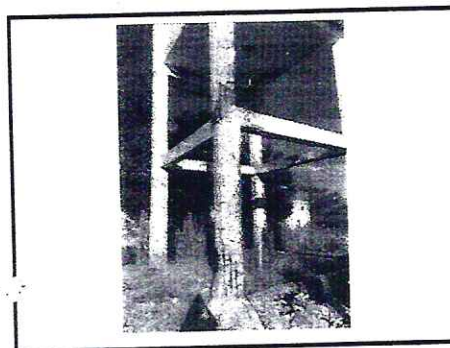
Pilar em grau de corrosão avançado (União)
